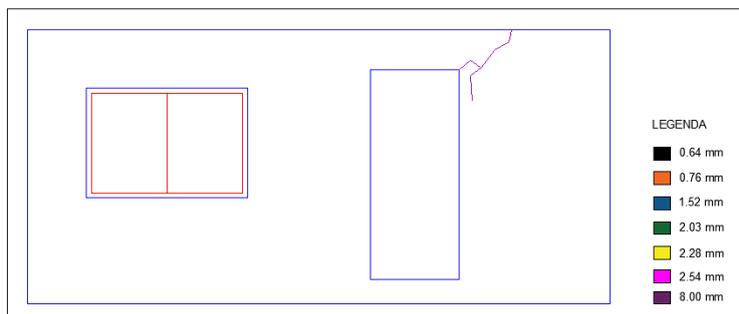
Levantamento arquitetônico. Fonte: Autor (2023).
